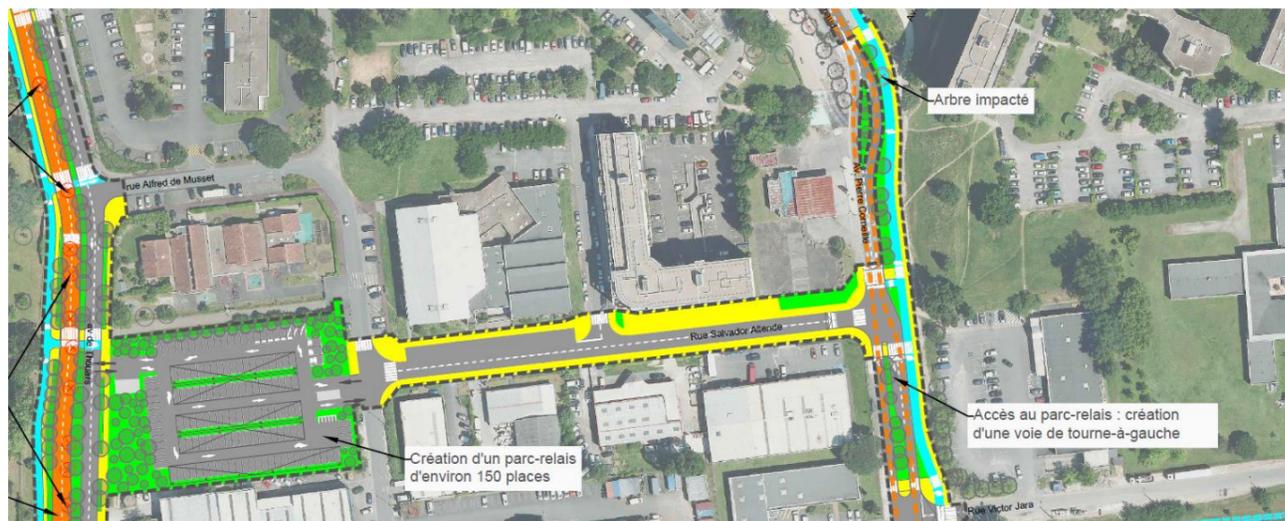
Extraits de plan sur l'insertion sur l'avenue Pierre Corneille
